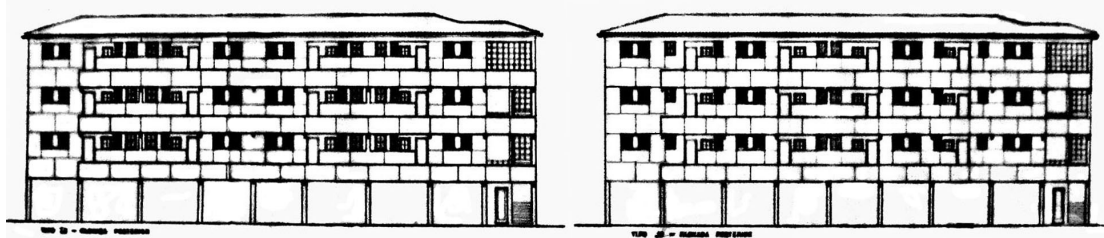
Fachadas posteriores Tipologias J1/J2 e I2. Fonte: arquivo INSS.
